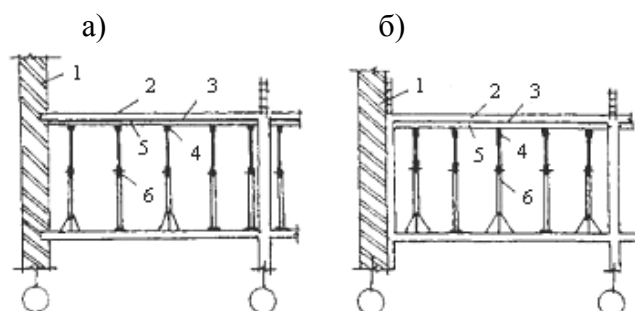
Варианты опирания монолитных перекрытий на наружные стены (а) и пристенные колонны (б)
